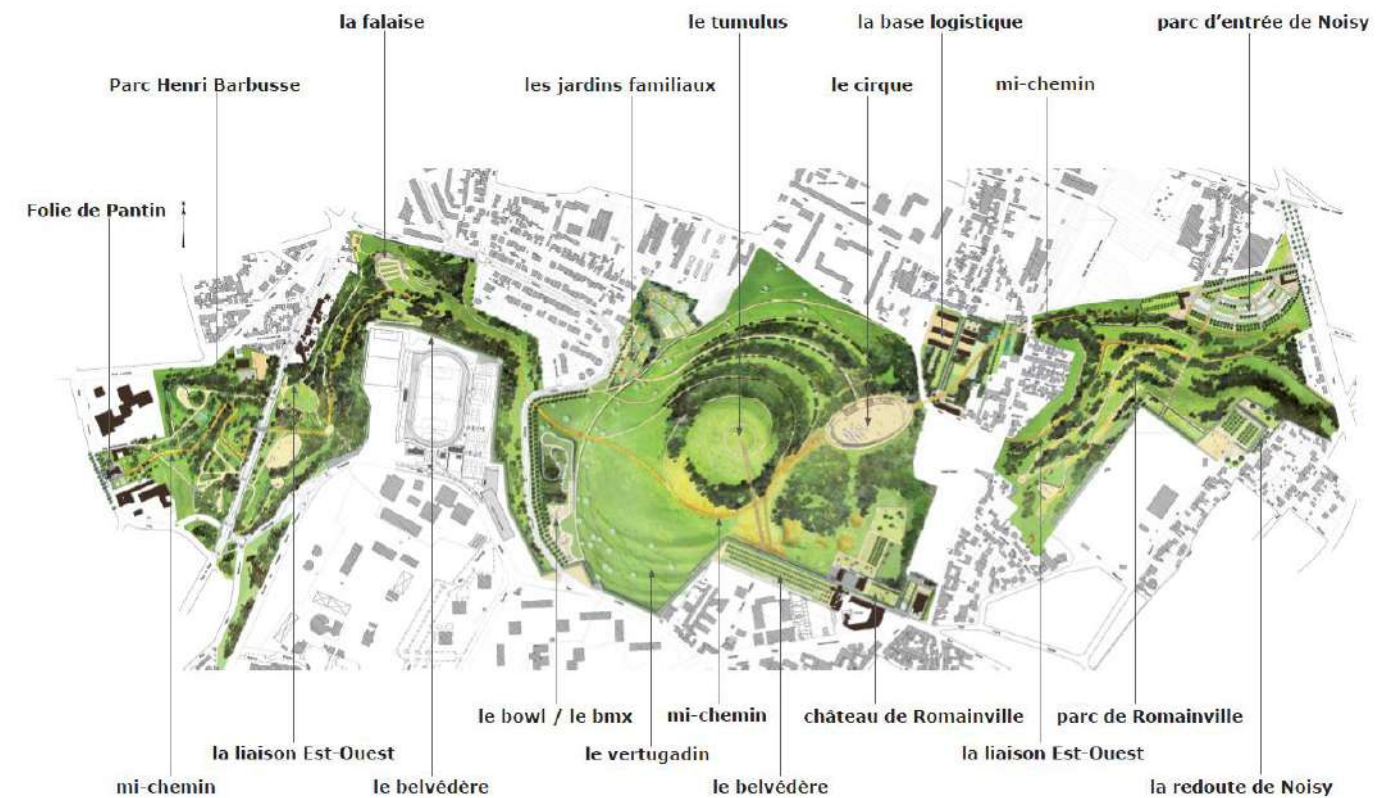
Plan de masse de l'AVP Général de 2009 – Source : ÎLEX
